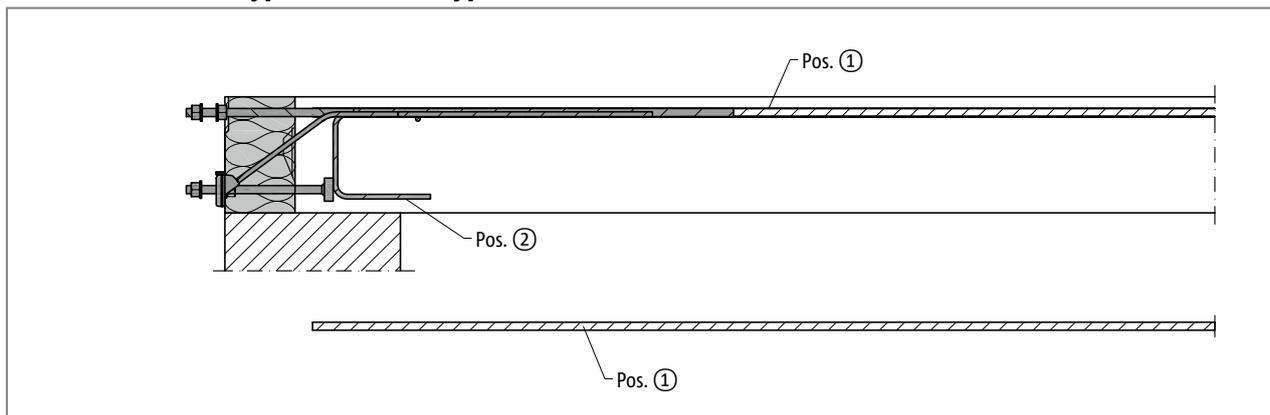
Schöck Isokorb® XT Typ SK-M1: Bauseitige Bewehrung, Schnitt
